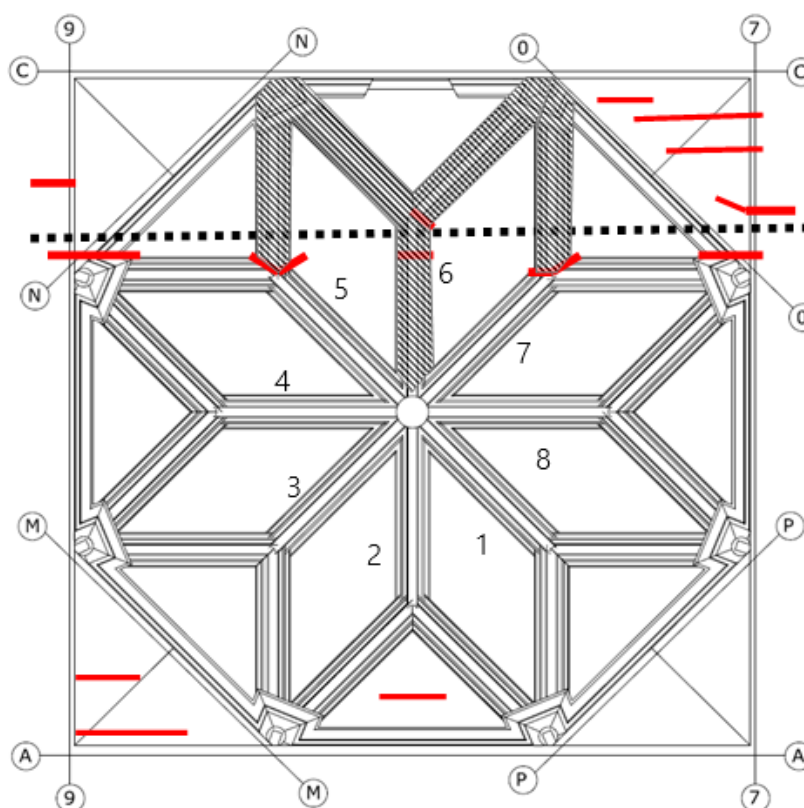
Situación de las grietas de la cúpula en planta.
